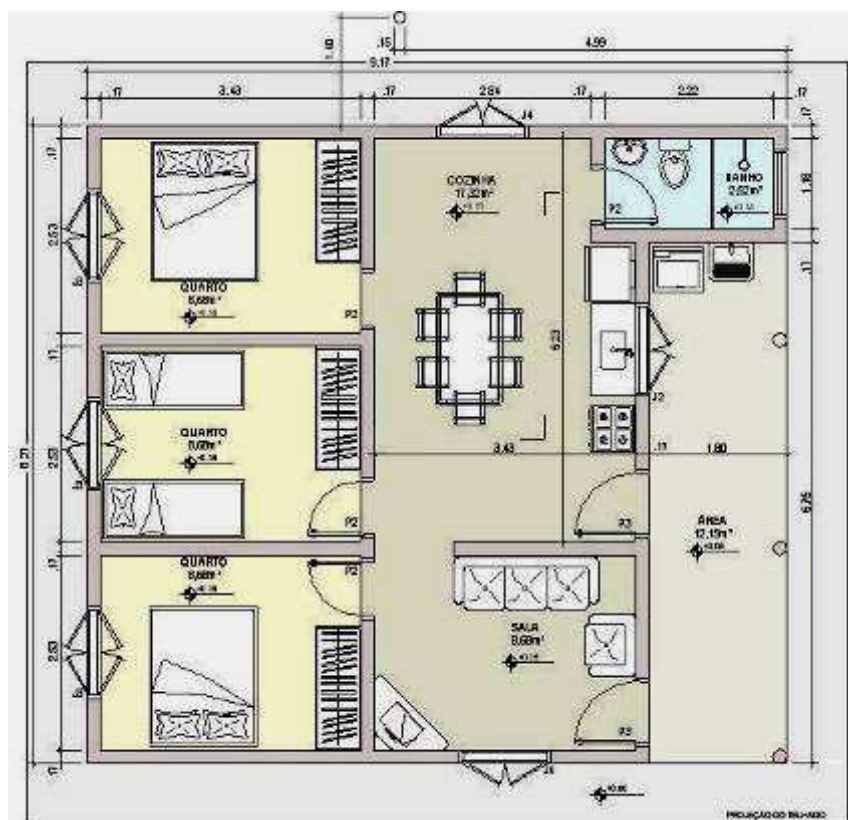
Planta da casa de adobe, com 104 m² de área de cobertura (acervo HABIS).
